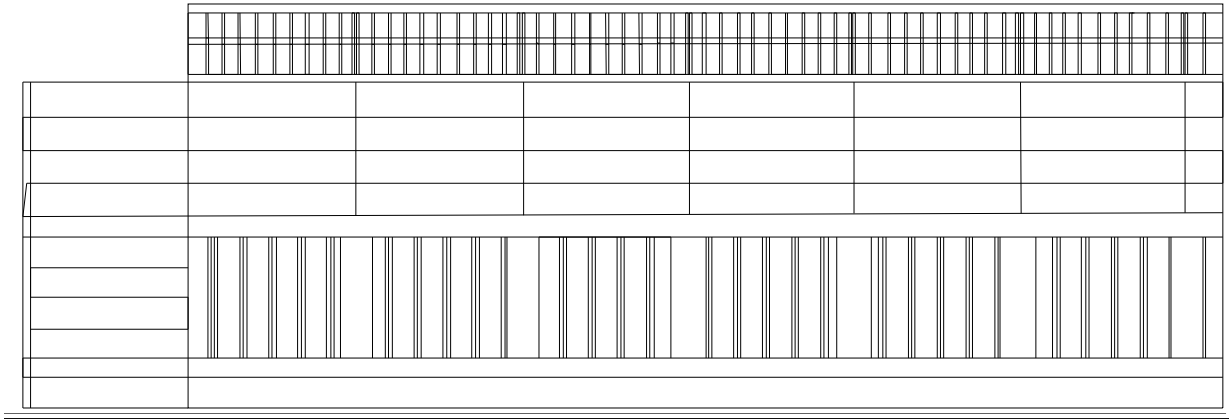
Пример решения фасада производственного здания из металлических панелей.
